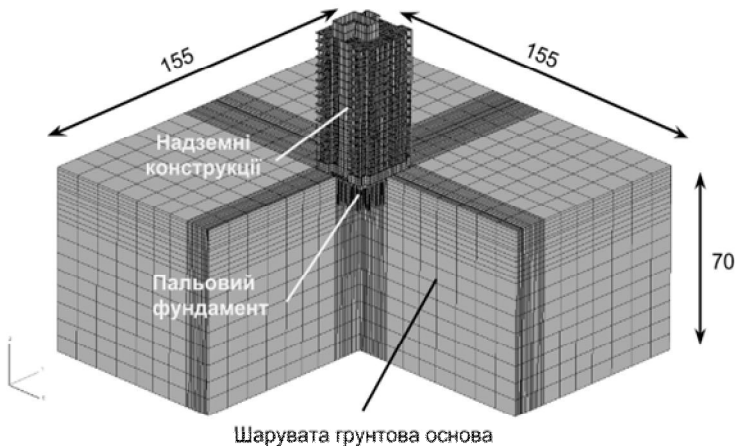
Скінченно-елементна модель будівлі, як системи "основа – фундамент – будівля"
